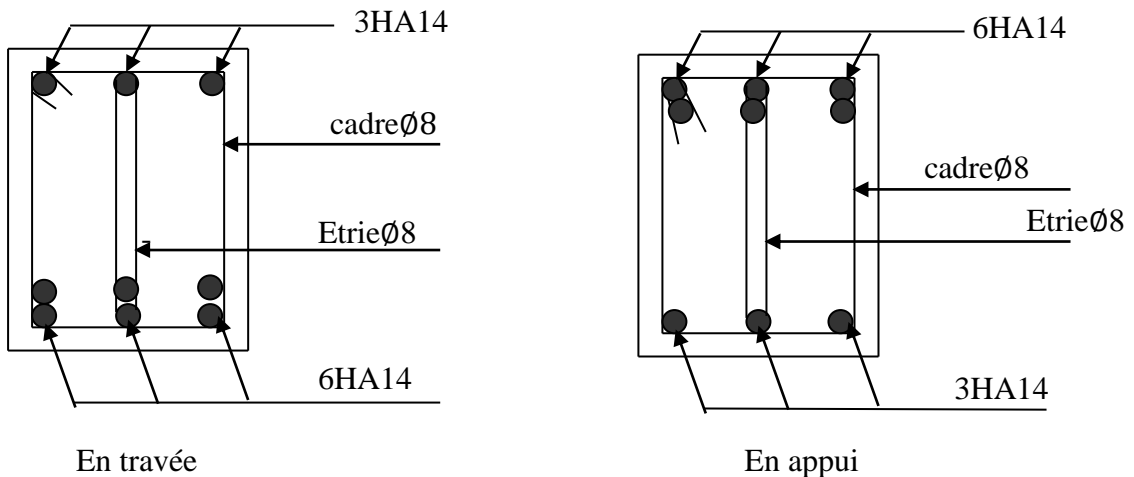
Schéma de ferrailage de la poutre brisée.
